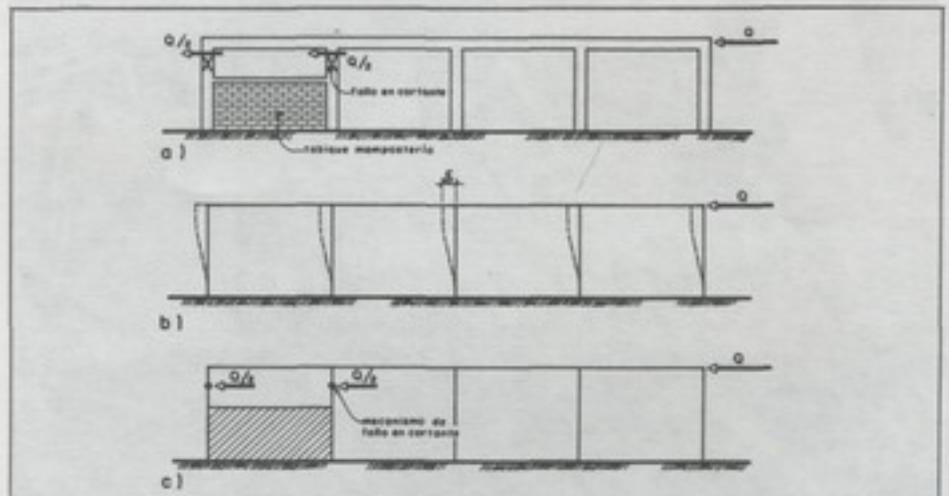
Efecto de Columna corta - a. Pórtico restringido parcialmente por tabiques de mampostería - b. Libre deformación del pórtico sin restricción de tabiques - c. Deformación restringida por tabique y mecanismo de falla en cortante.
